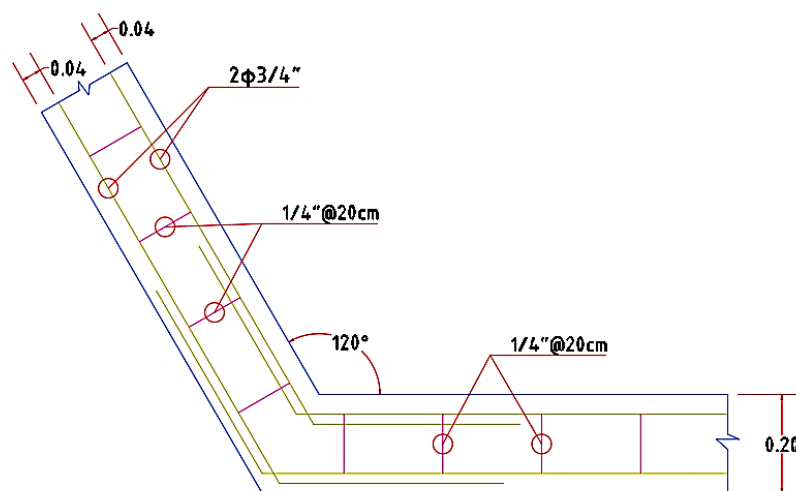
Detalle 4- Intersección de las vigas inclinadas
